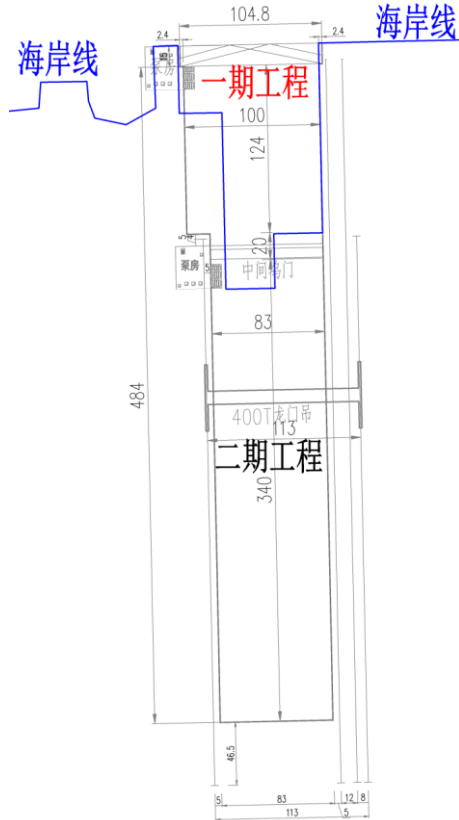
大型高端海工装备配套升级改造项目拟建船坞平面布置图
